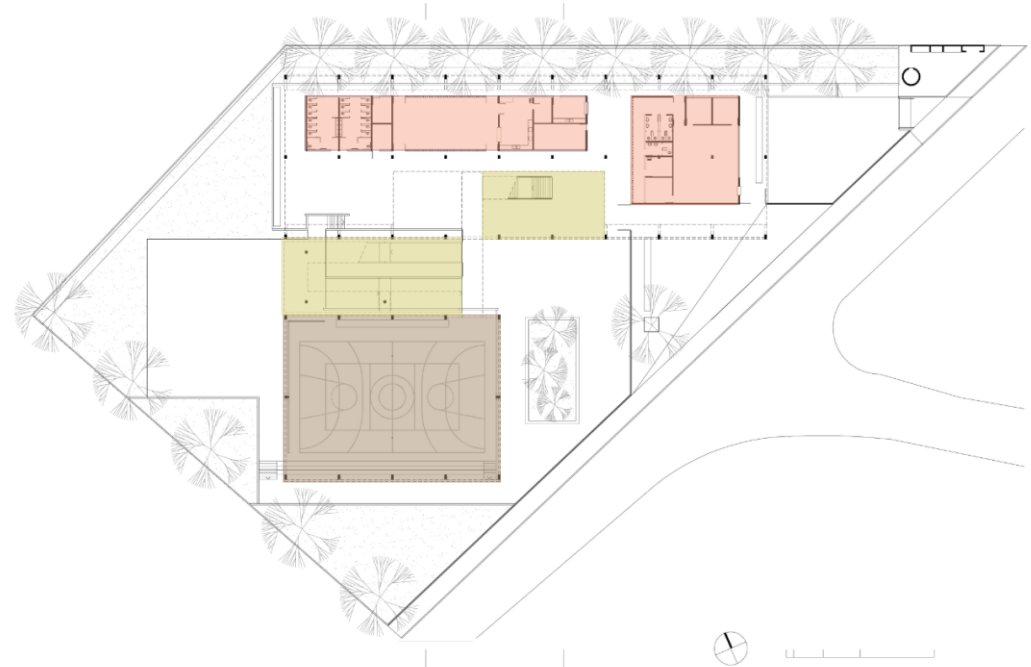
Planta Baixa Térreo - Fonte: Archdaily
